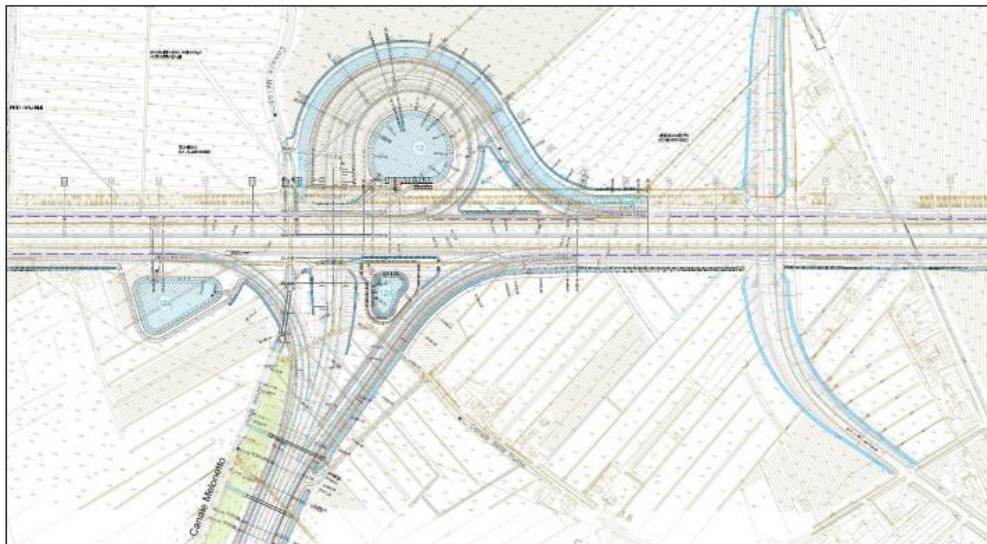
Dettaglio planimetrico sul nuovo svincolo estratto dalla planimetria di progetto di cui all'elab.E.02.00.0.0
